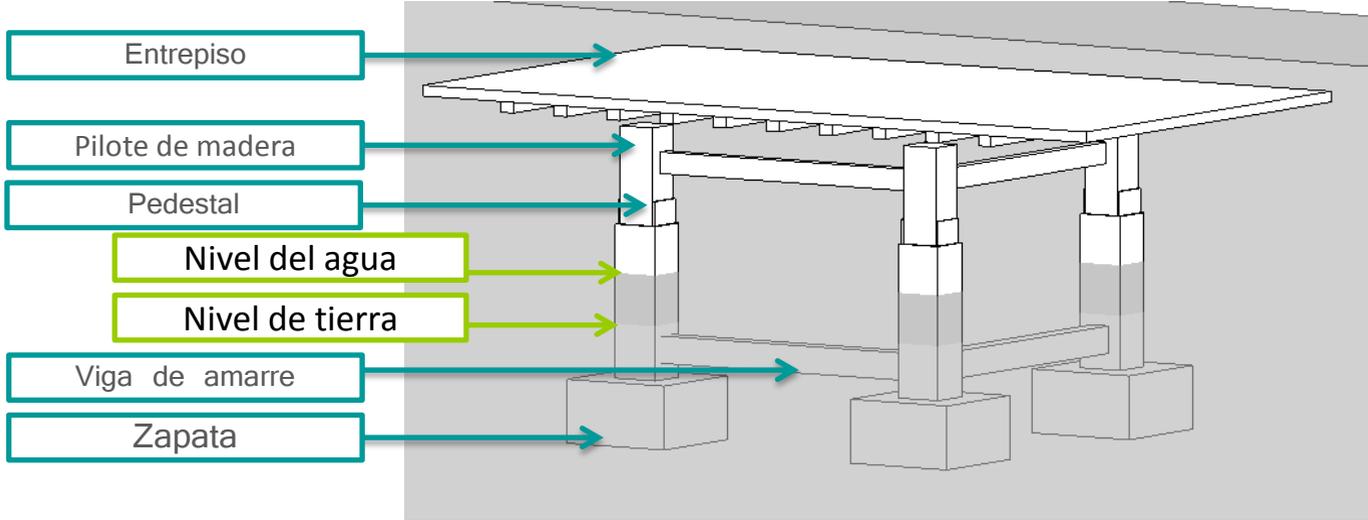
Cimientos bajo el agua sobre pilotes con vigas de amarre
